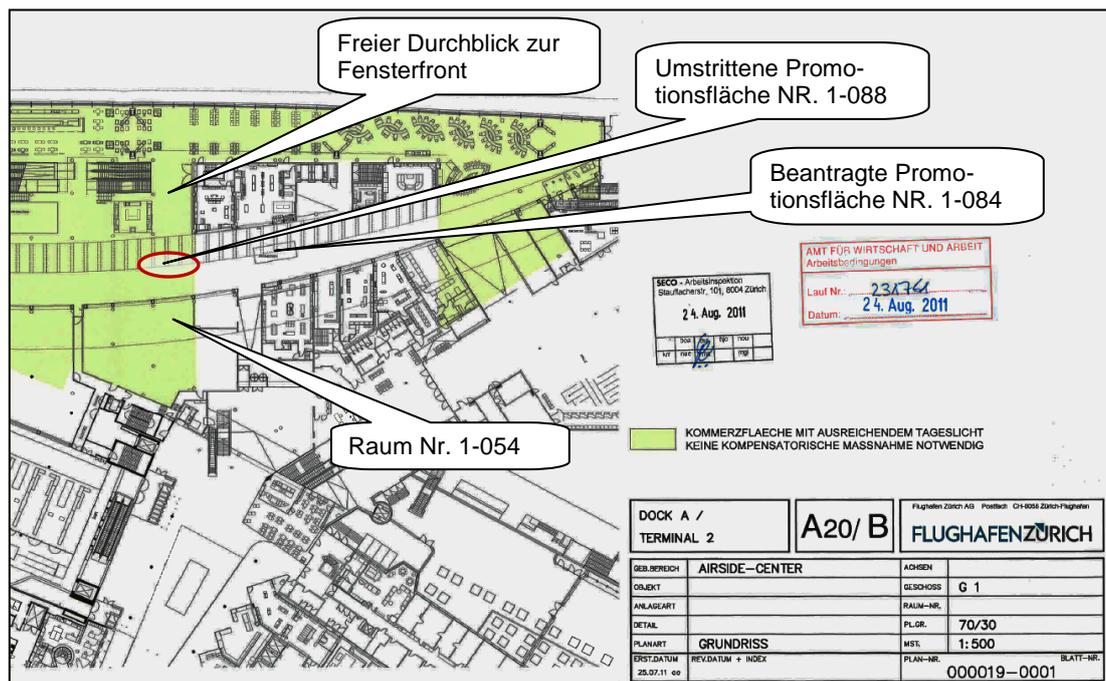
Von SECO und AWA genehmigter Plan betreffend ausreichendem Tageslicht (Ausschnitt) mit Situation Raum-Nr. 1-054 und Promotionsfläche Nr. 1-088
